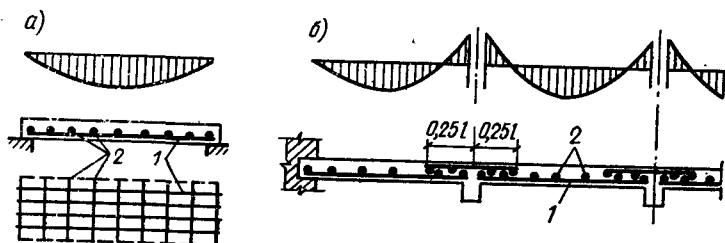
Армирование плит и эпюры моментов при равномерно распределенной нагрузке
